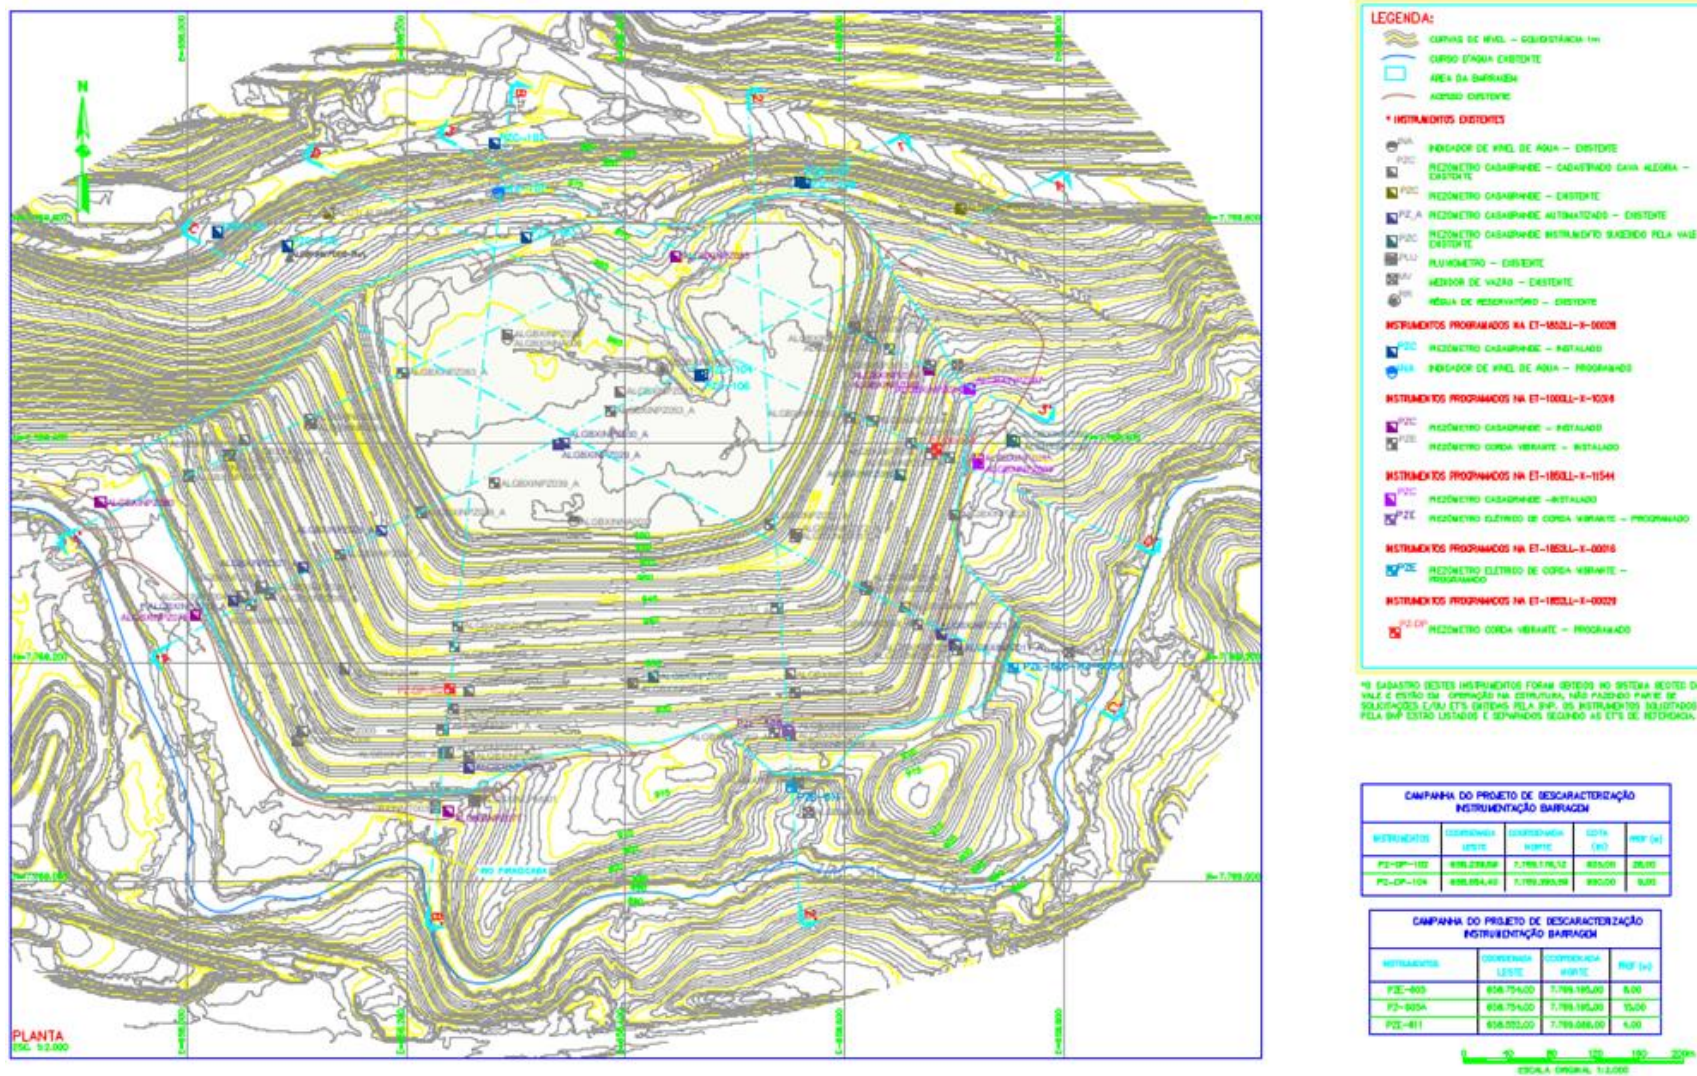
Planta de instrumentação complementar para descaracterização (piezômetros).
